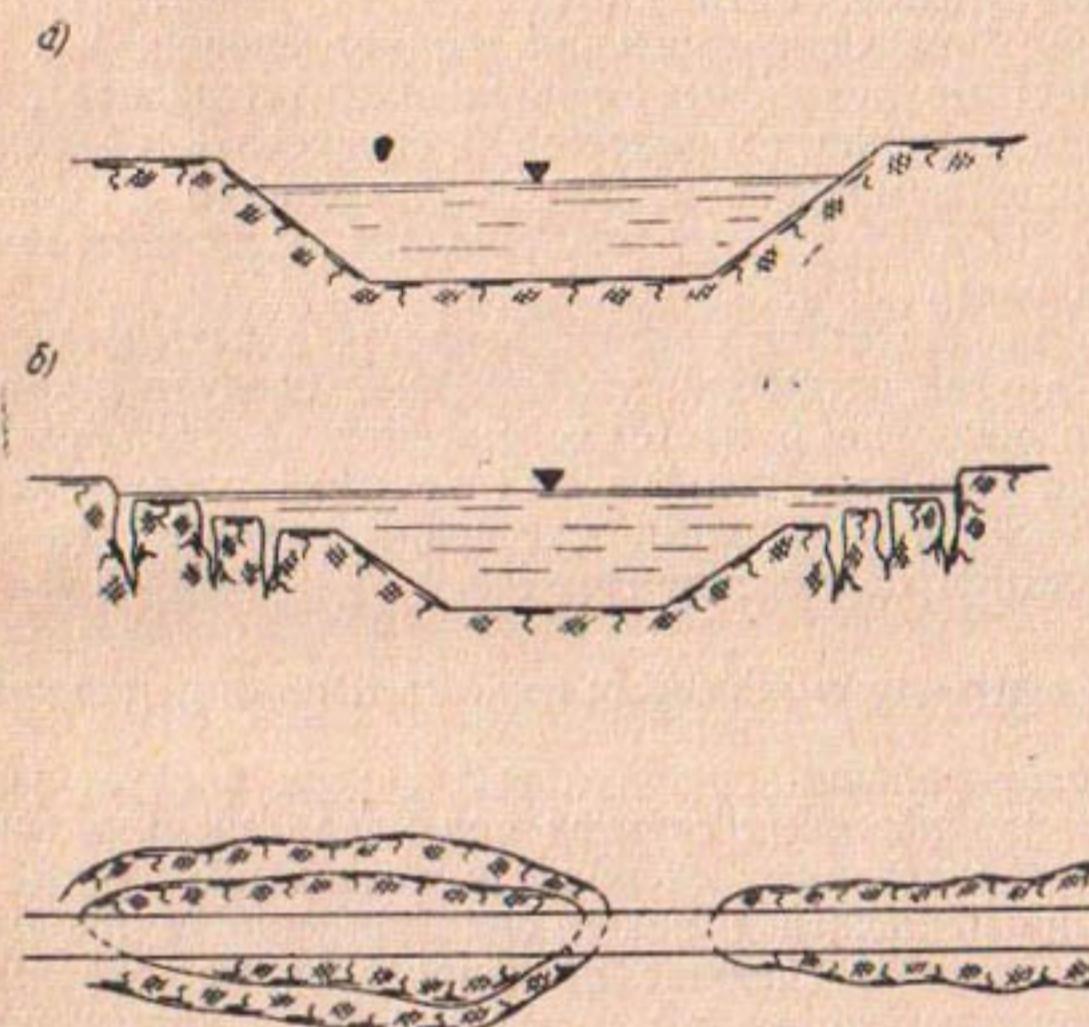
Просадки на каналах в поперечном разрезе и в плане:
